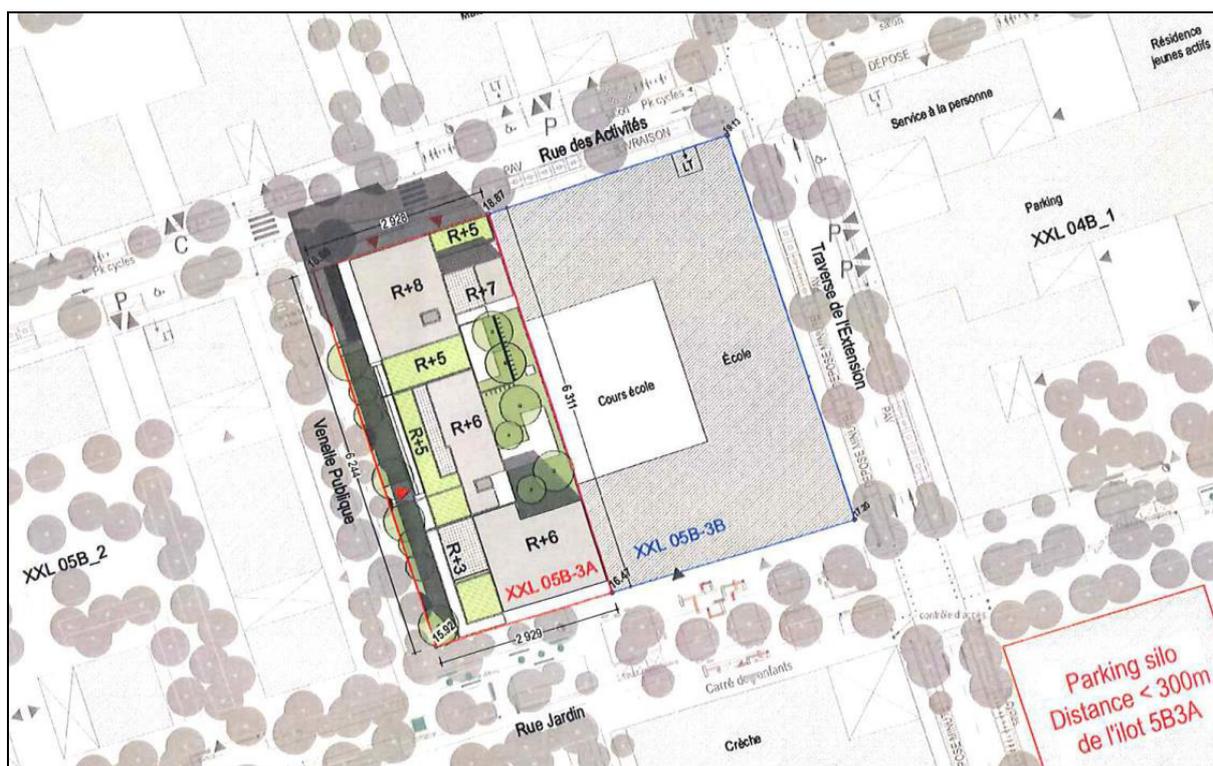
Plan de toitures (source : Linkcity, 2020)
